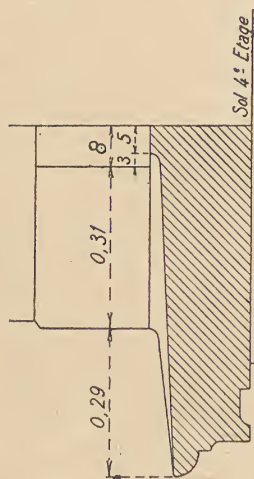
Coupe du balcon du 4° étage suivant II.
